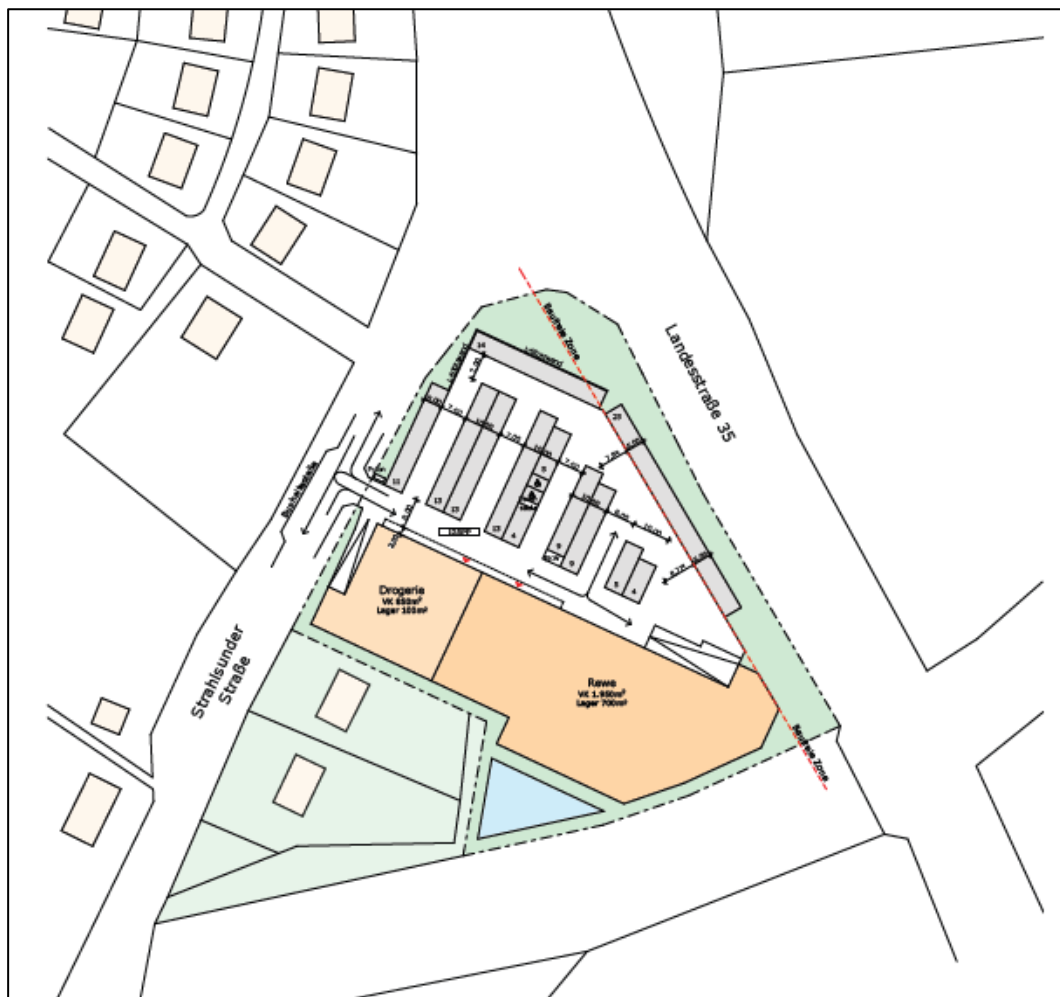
Lageplan zur Grundstücksbebauung⁷
